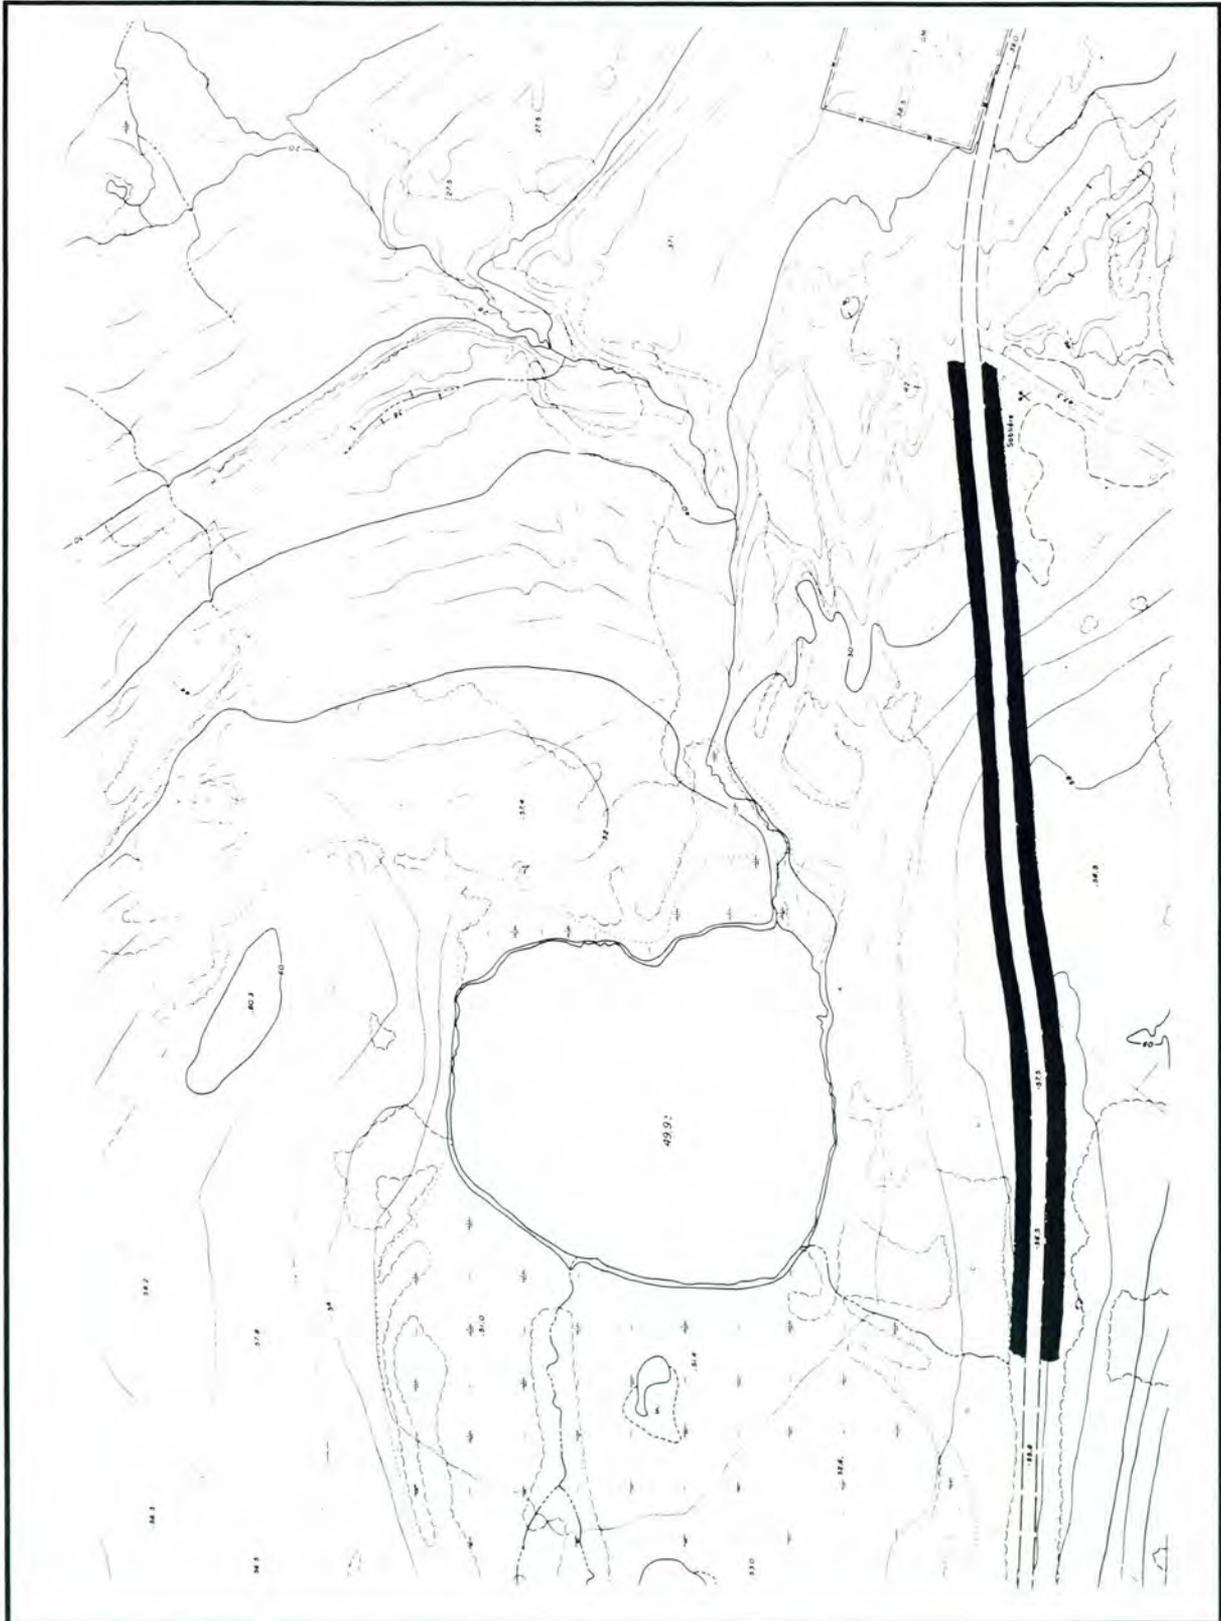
Blanc-Sablon, secteur 5+177 à 5+800 (SO)
